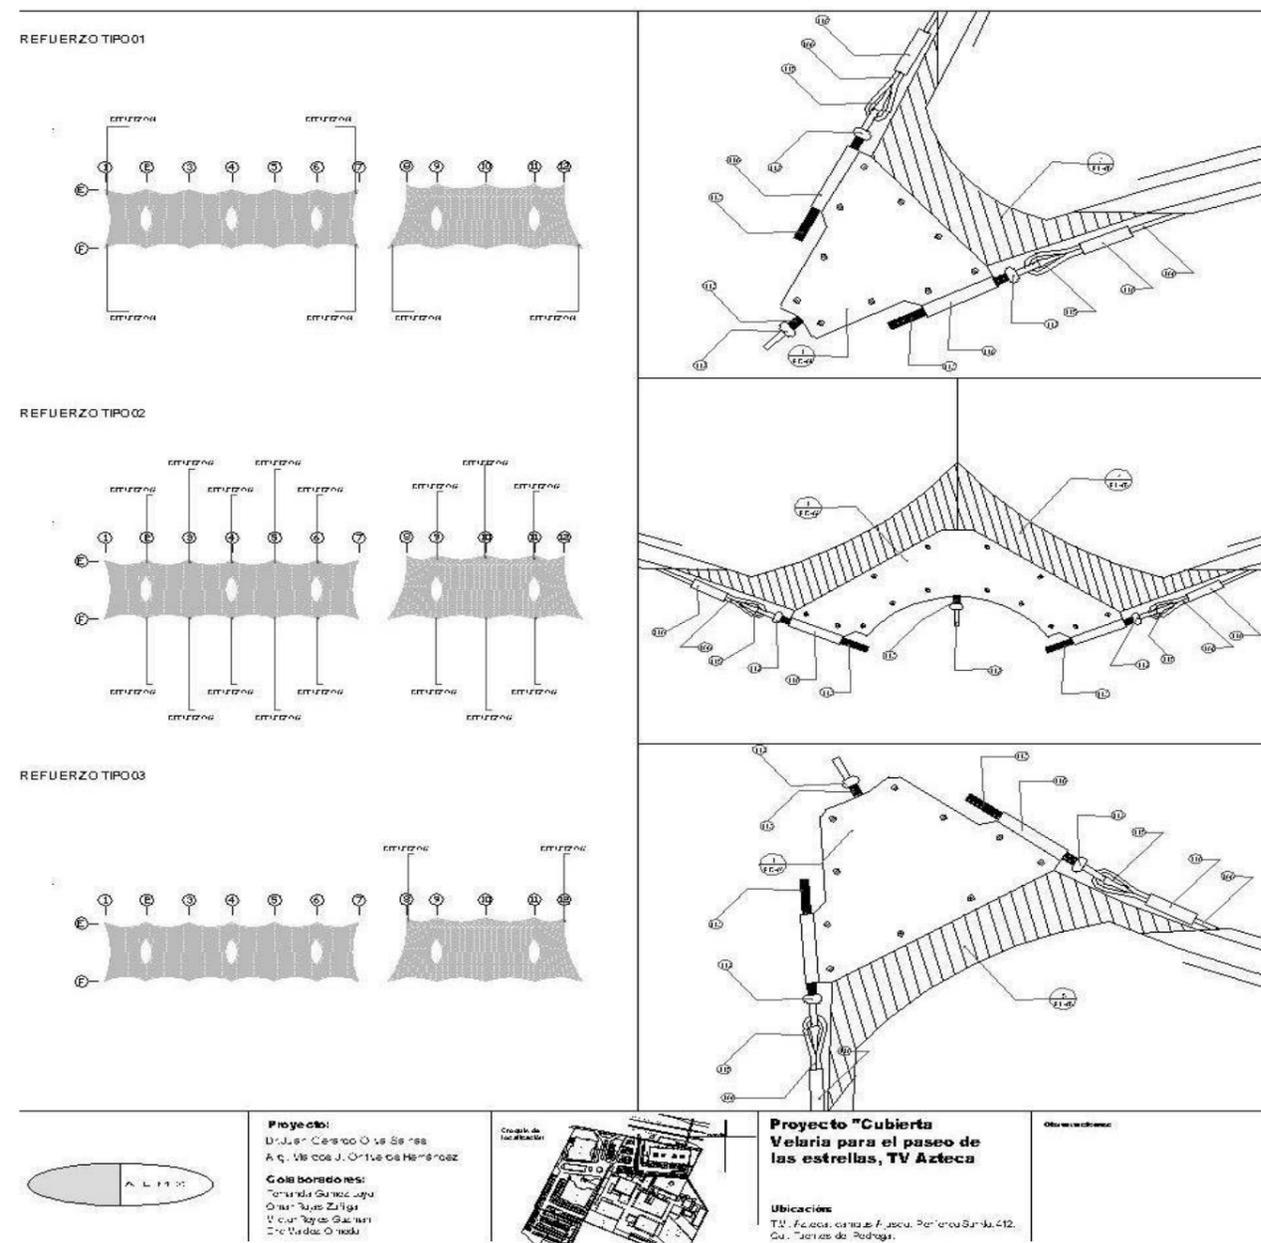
DETALLES DE REFUERZOS EN PUNTA DE MEMBRANA
